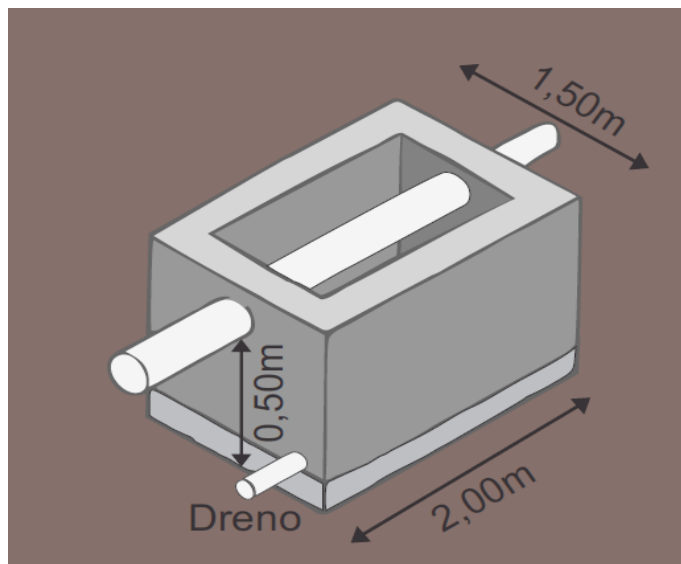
Proposta da caixa para instalação dos equipamentos de medição.
